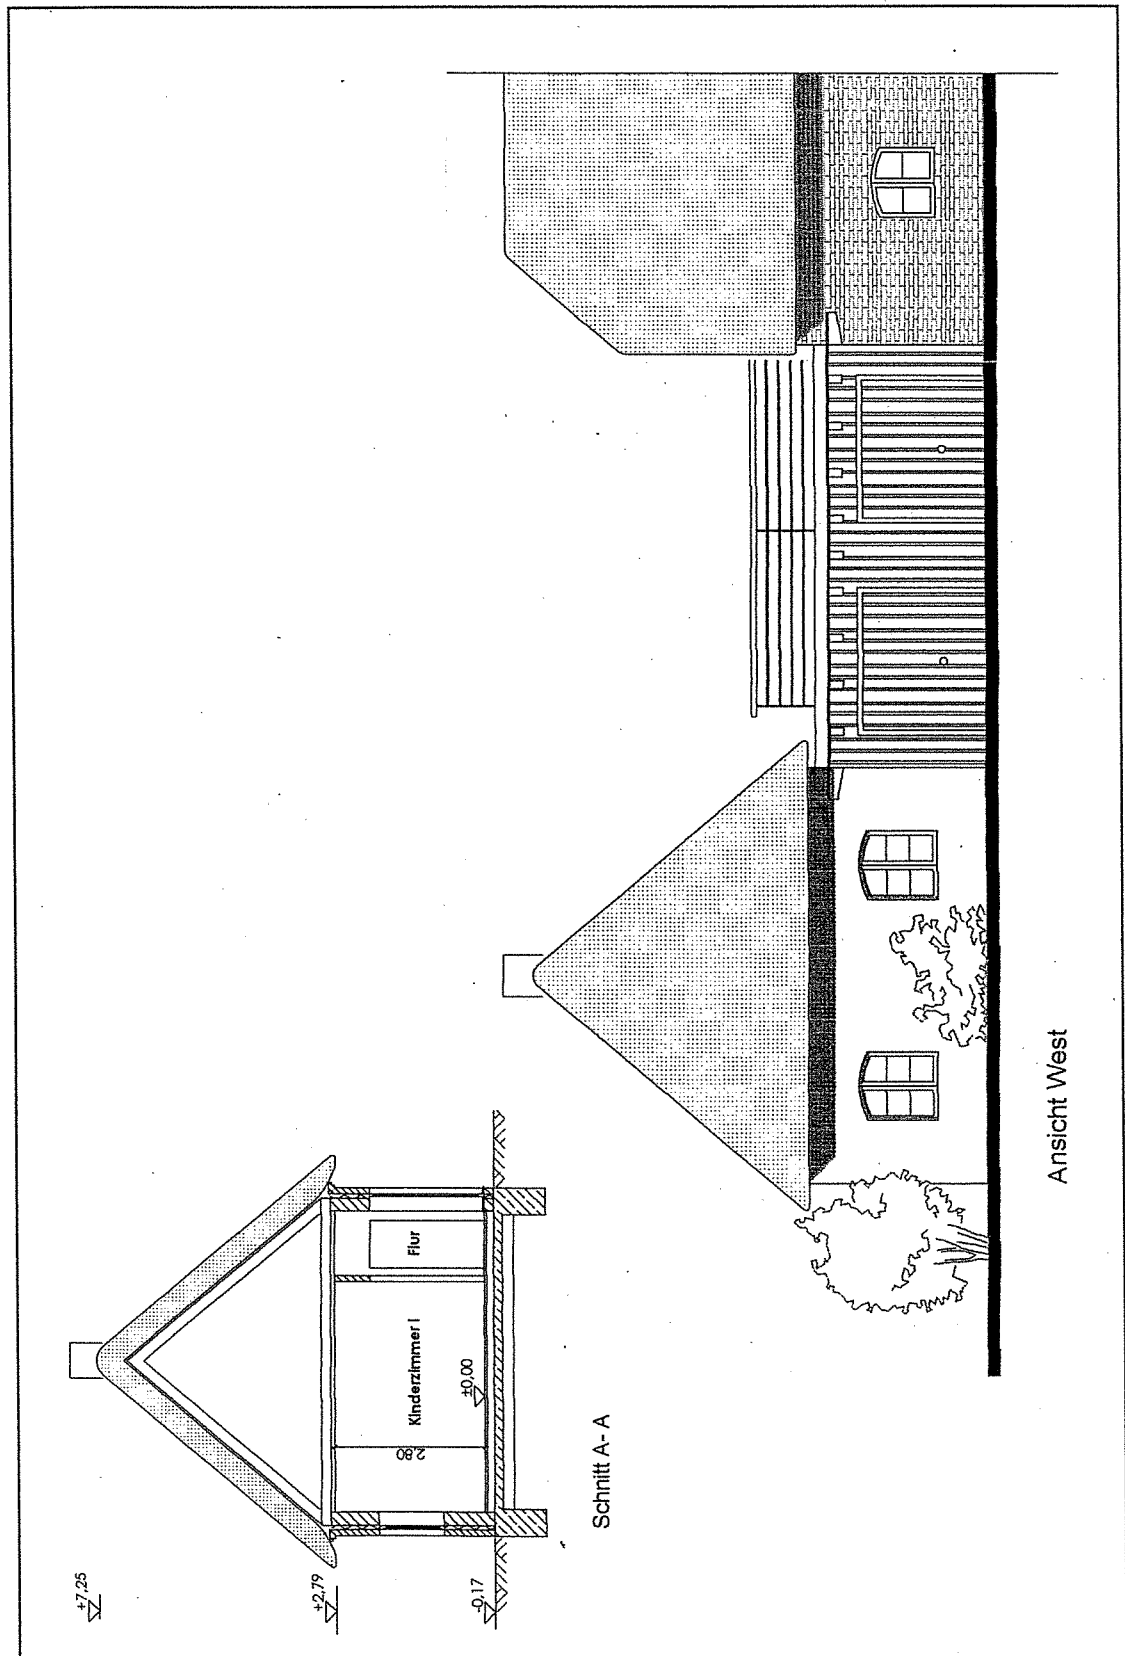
Ansicht des geplanten Anbaus an das vorhandene Wohngebäude mit Doppelgarage Ewers Haus-Nr. 6 und Schnitt durch den geplanten Anbau entsprechend den Bauantragsunterlagen vom 10.09.2004
